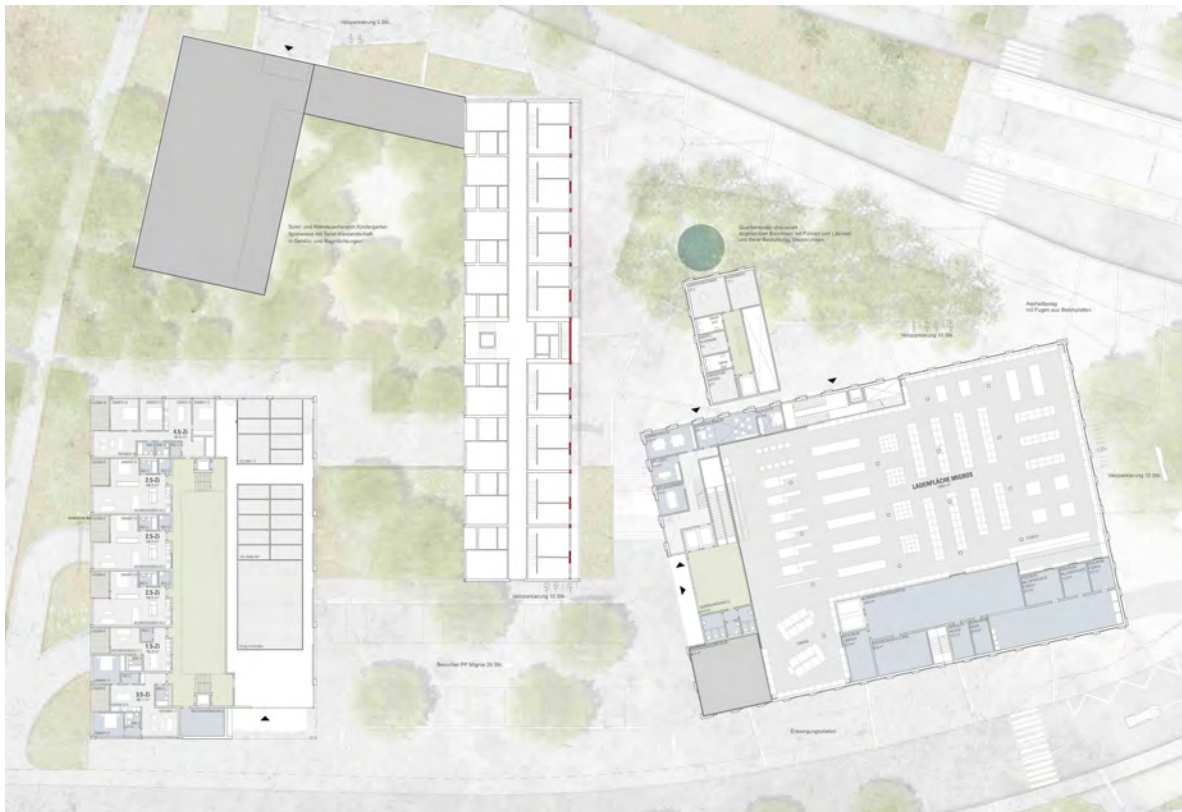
ohne Kennwort: Grundriss Ebene Kesslerstrasse
